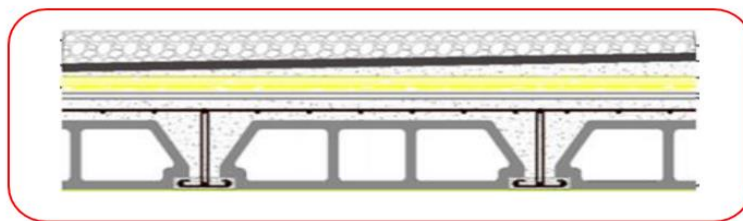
Coupe d'un plancher terrasse inaccessible à corps creux
